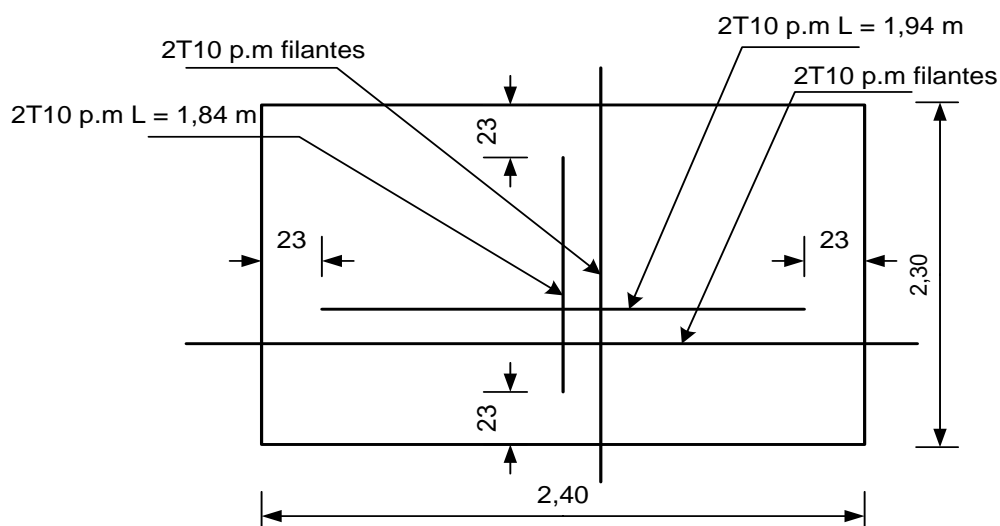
Ferrailage inférieure (en travée) du panneau de dalle d'ascenseur
